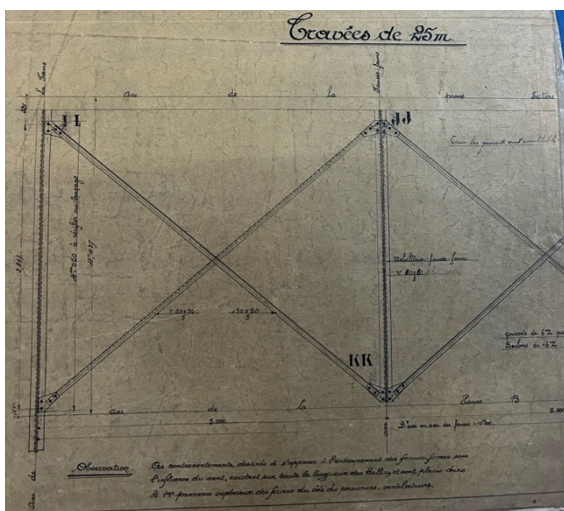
Plan d'un panneau de contreventement entre colonnes, Exposition de Bruxelles 1910
